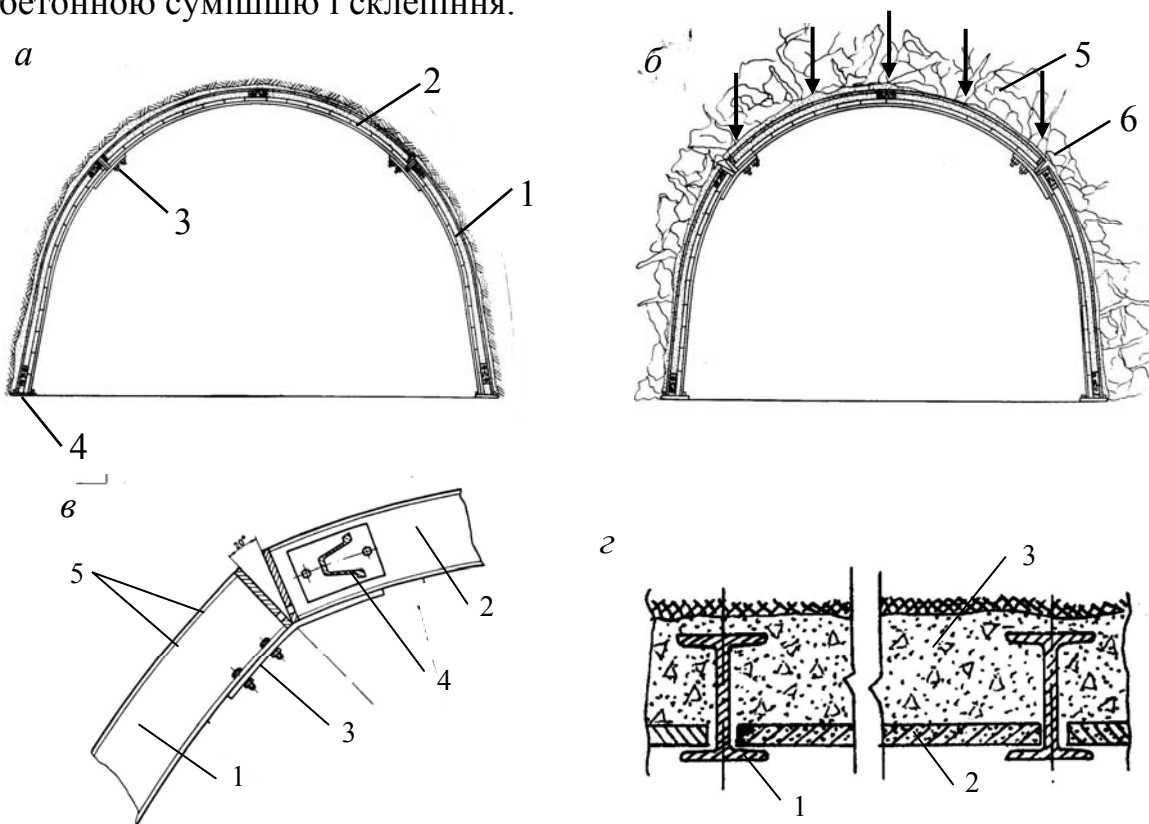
Конструкція шатрового бетонного кріплення:
